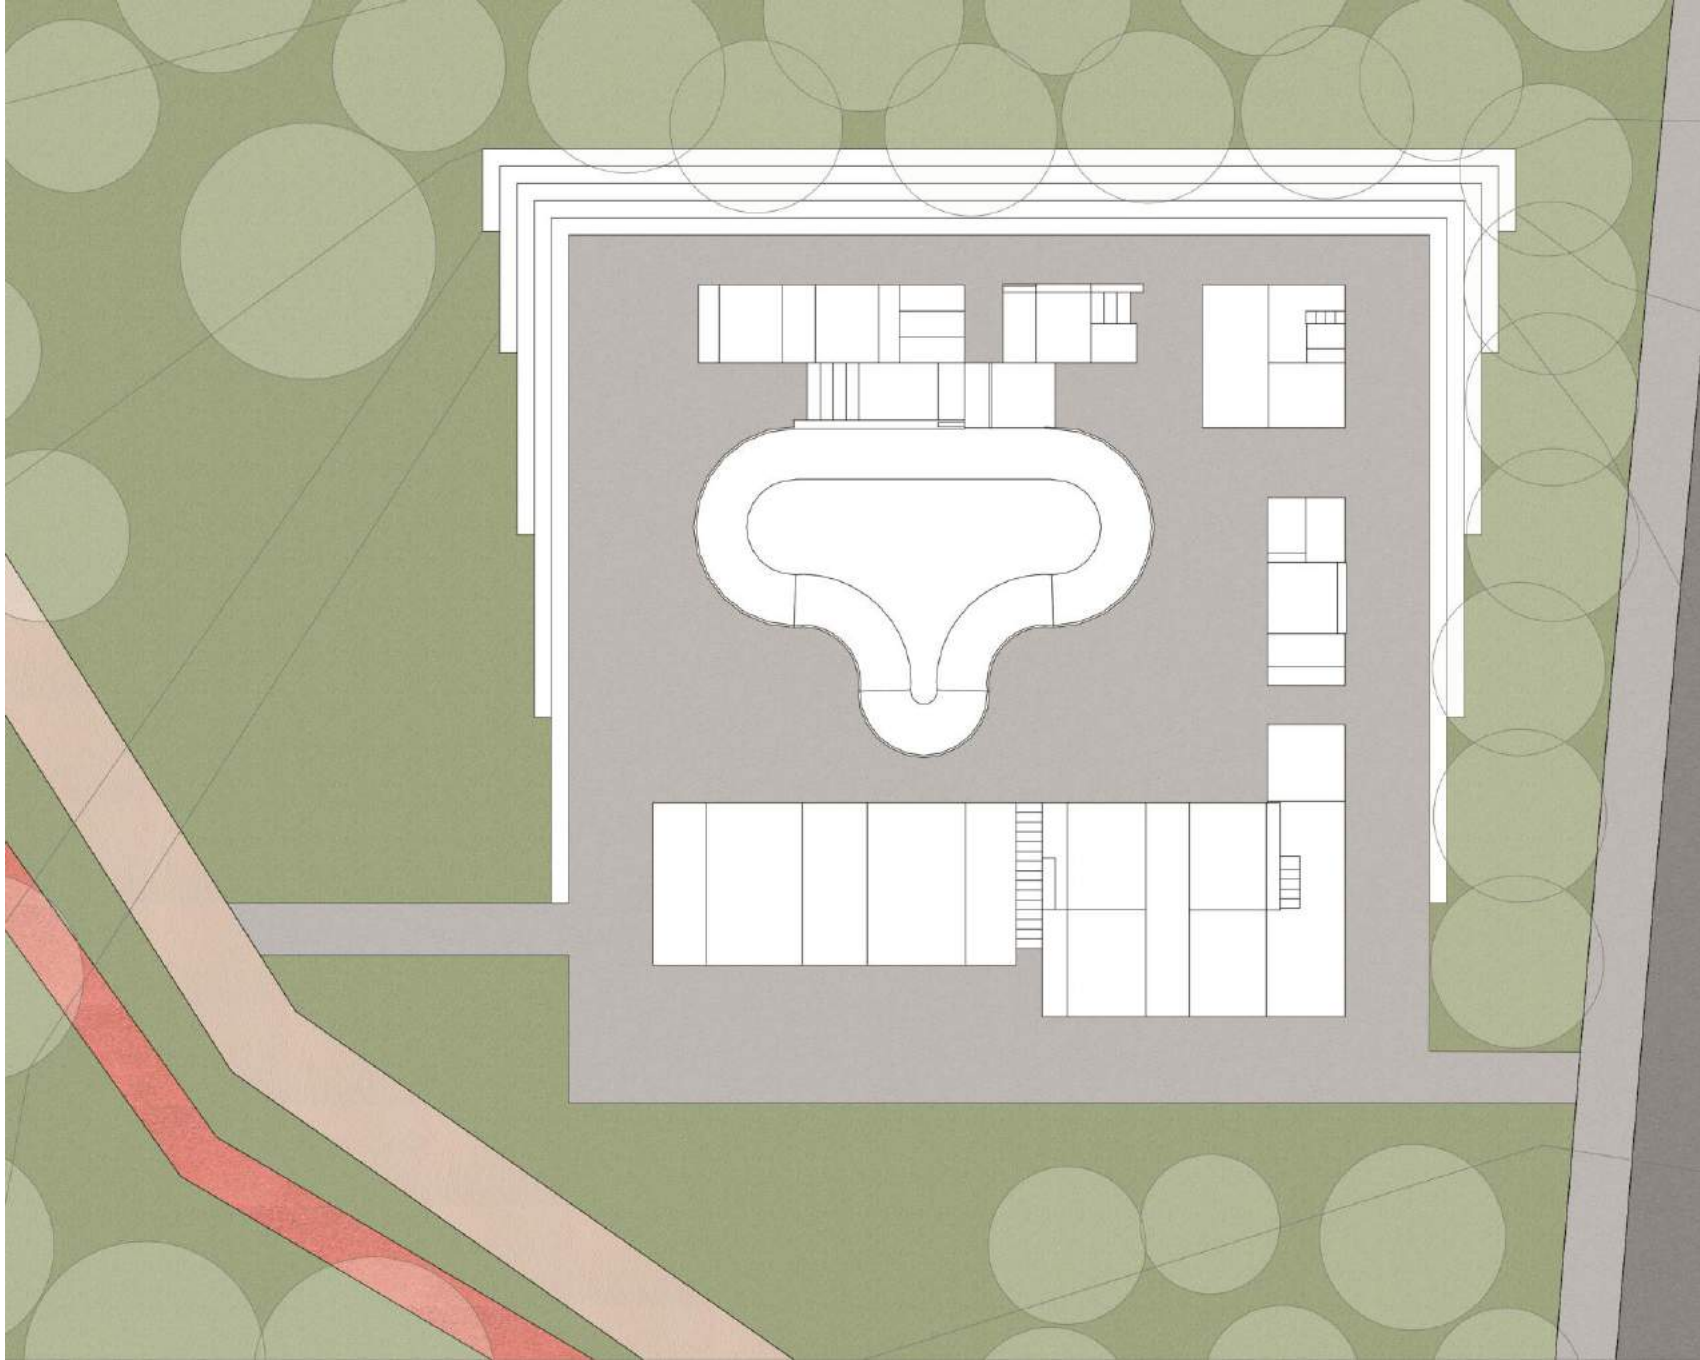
Planta área de pista de skate. Fonte: elaborado pela autora.
